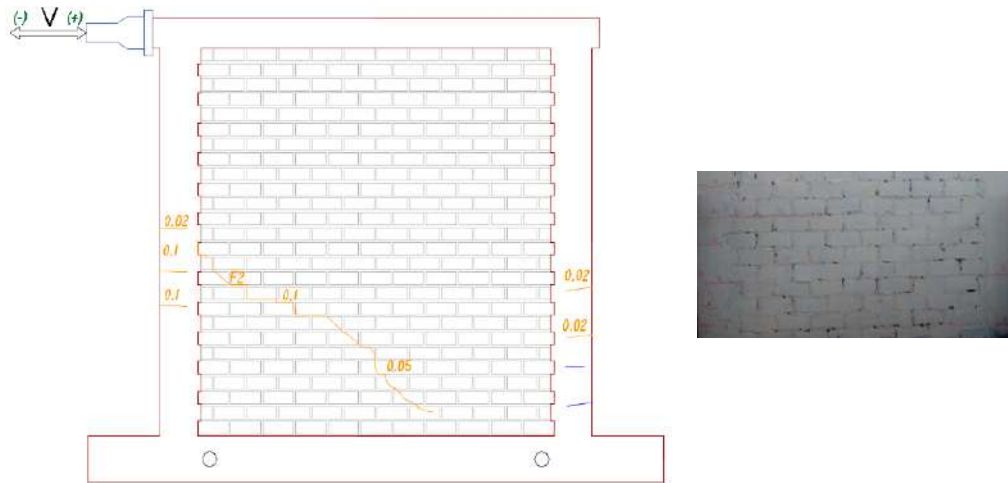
Fase 2, fisuras en ambos talones y escalonado.
